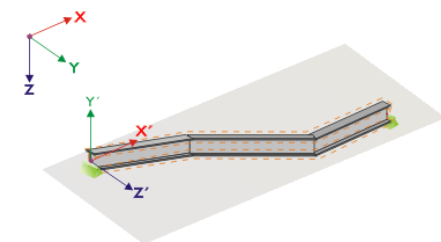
Coordenada auxiliar dos apoios nodais - conjunto de barras no plano horizontal.
